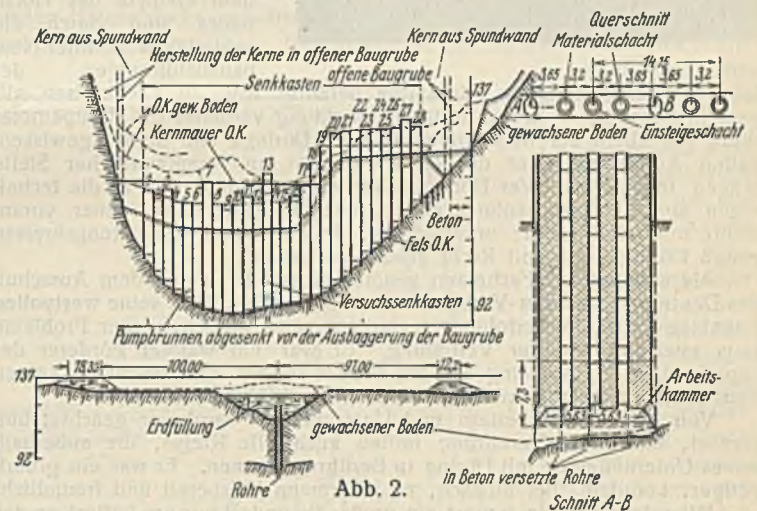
in Beton versetzte Rohre Schnitt A-B
